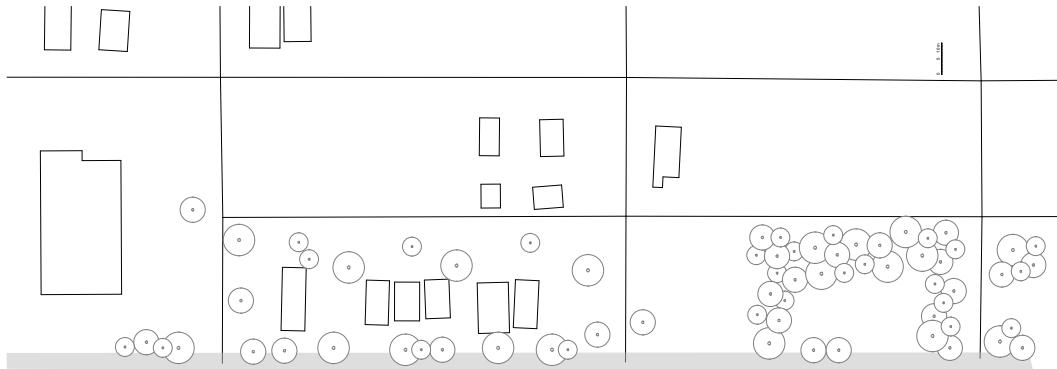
Ausschnitt Grundriss Zone 3
